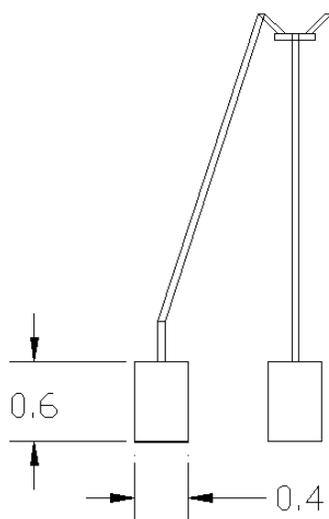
Hoyos de 45 centímetros y columnas de soporte estructural vertical.
